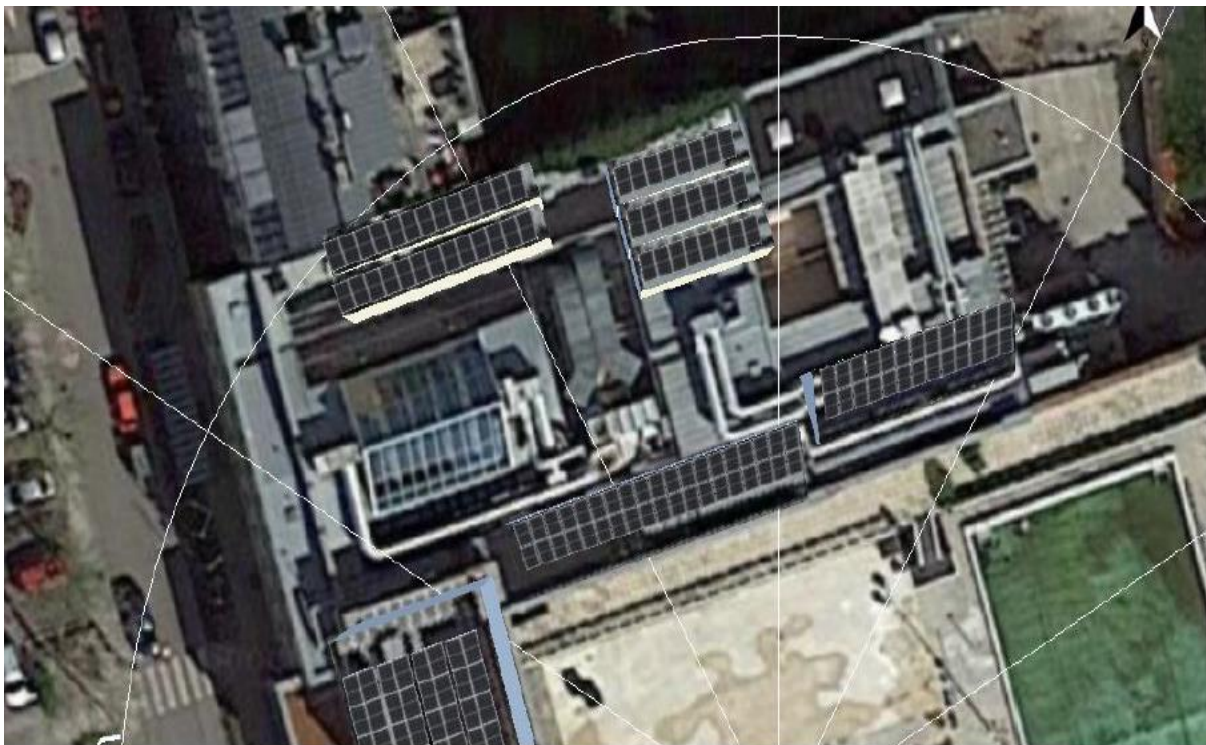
Geplante PV-Anlage Stadtbad 2 - Stand Ende 2022
